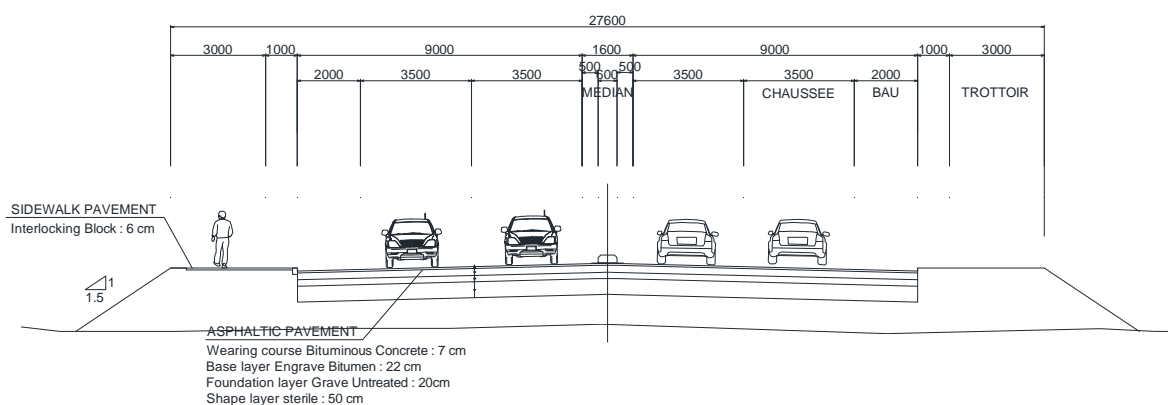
Coupe transversale type de la section de route du pont (pour référence)
